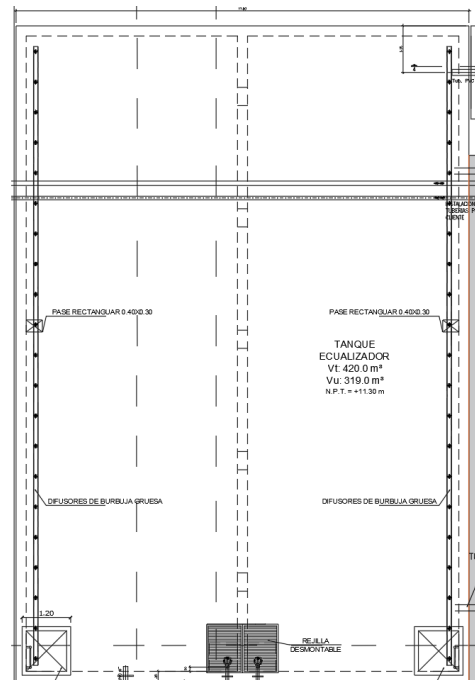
Vista en planta de la arquitectura del tanque ecualizador.
